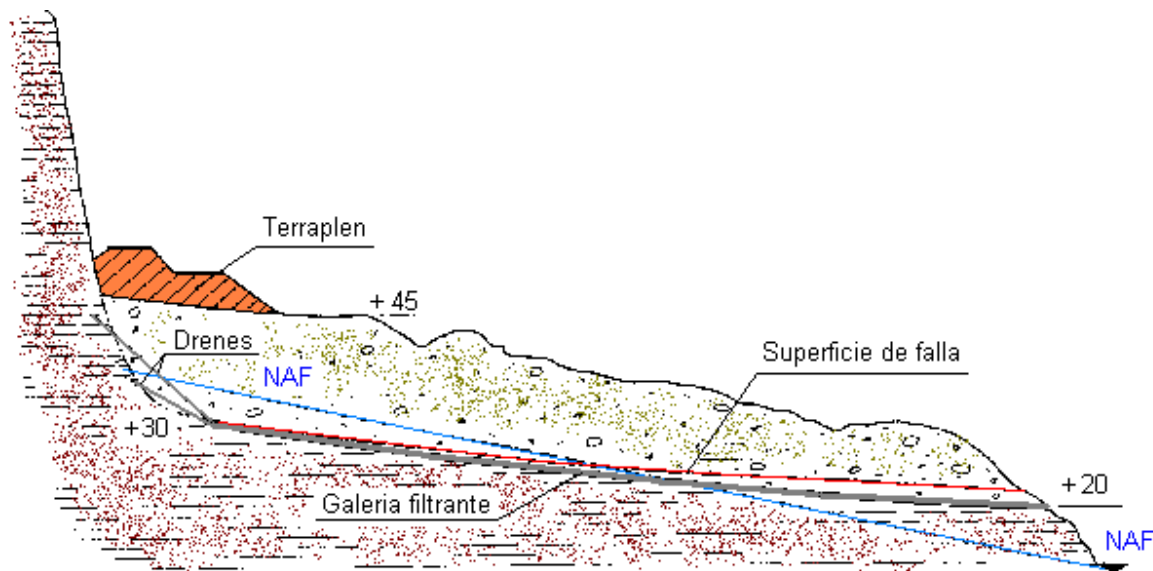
SECCIÓN Y CORTE DE UNA GALERÍA FILTRANTE
